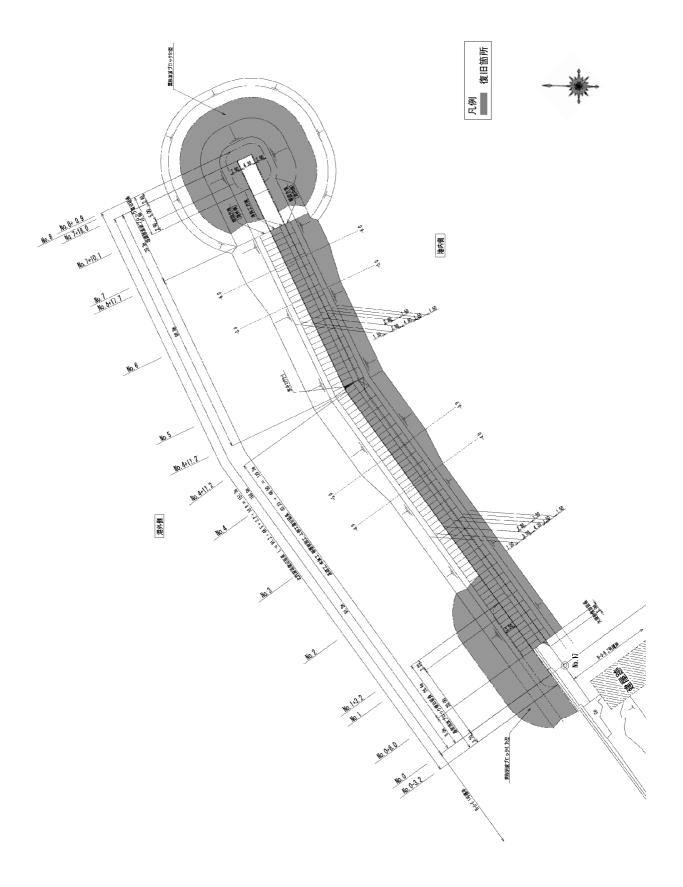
No.11 玉の脇地区_北防波堤の平面図(復旧後)
